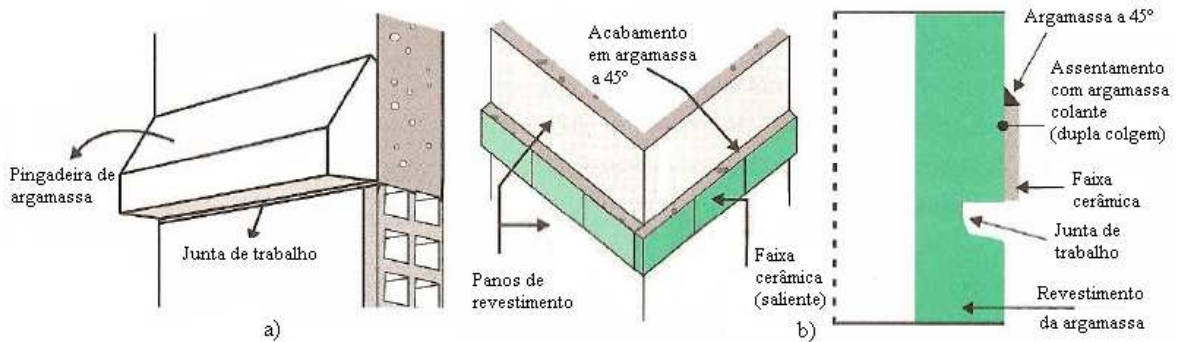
Detalhe de pingadeiras (a) de argamassa; (b) de pedra ou cerâmica (Leggerini e Aurich, 2009).
